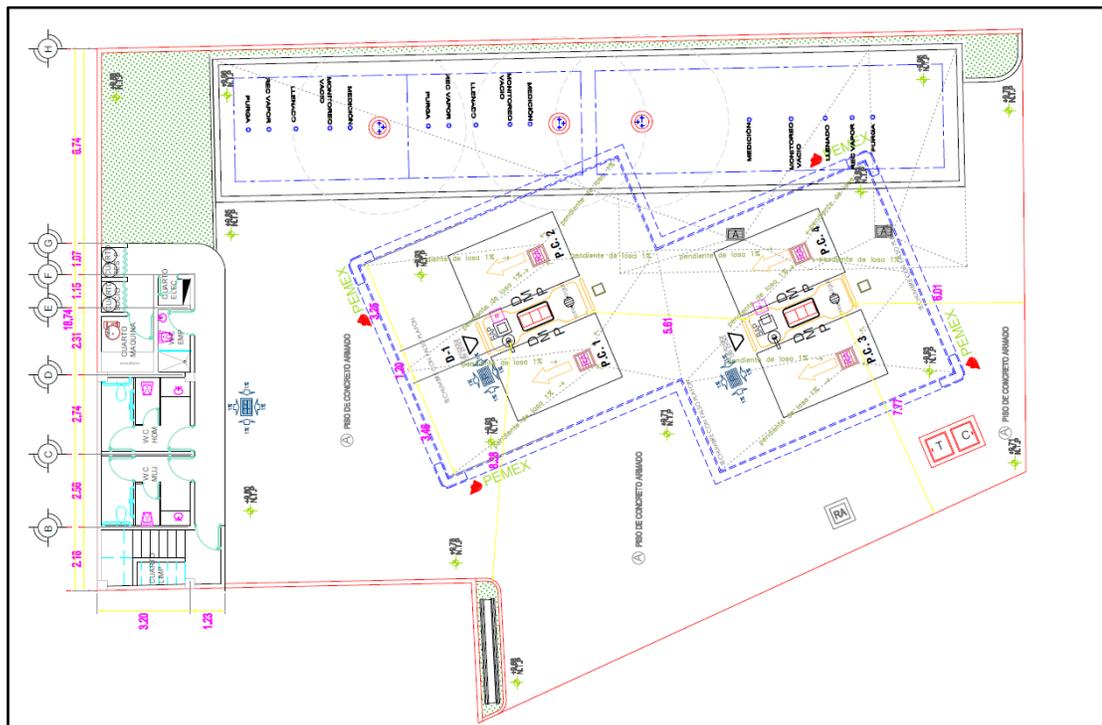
Vista general de la Estación de Servicio. Fuente: Plano Arquitectónico.
